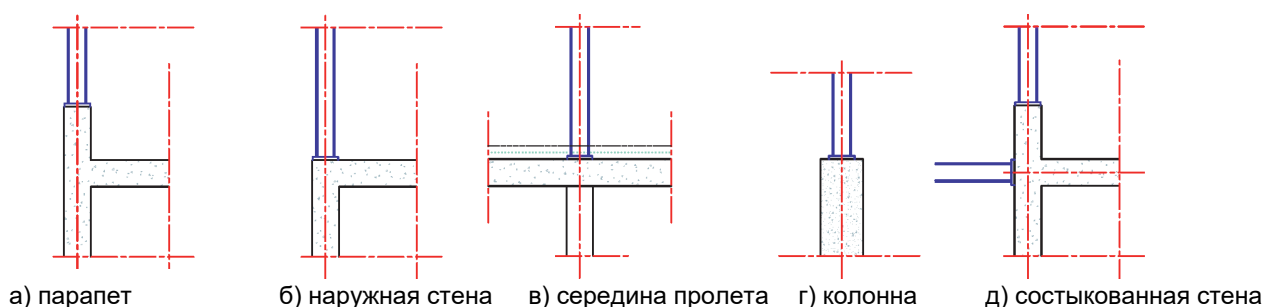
Различные типы узлов: соединение колонны с бетонной стеной
